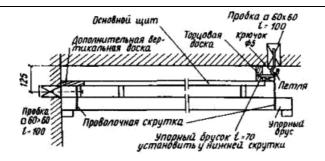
Крепление щитов сборно-разборной щитовой опалубки при утеплении наружной стеновой панели
